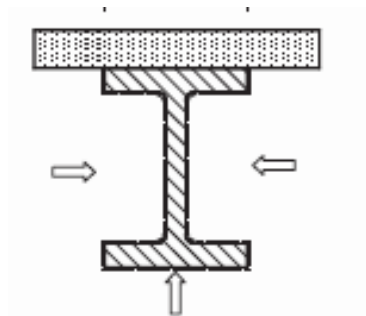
Proteção da Viga - Argamassa Projetada Blaze Shield II.
